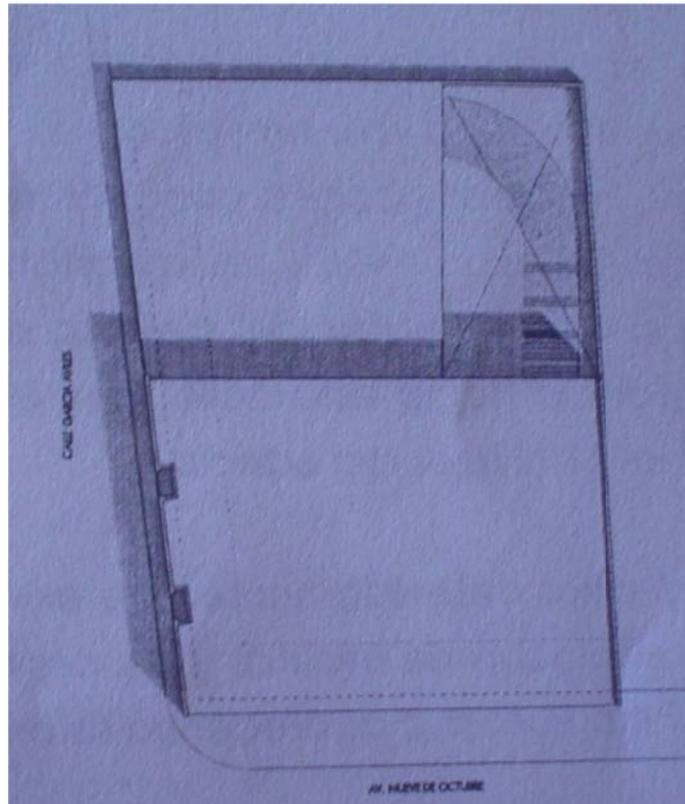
Implantación dentro del terreno. Fuente: Tesis Lata Guamán, Oswaldo. ALAMIRO GONZÁLEZ. OBRAS Y PROYECTOS ENTRE 1960-1970
